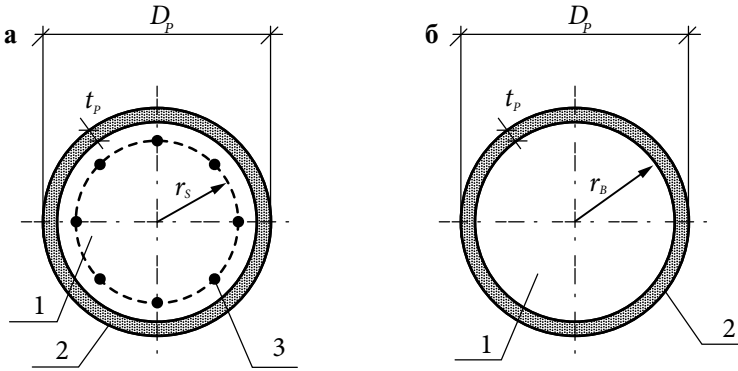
Виды сталежелезобетонных колонн с жесткой арматурой
